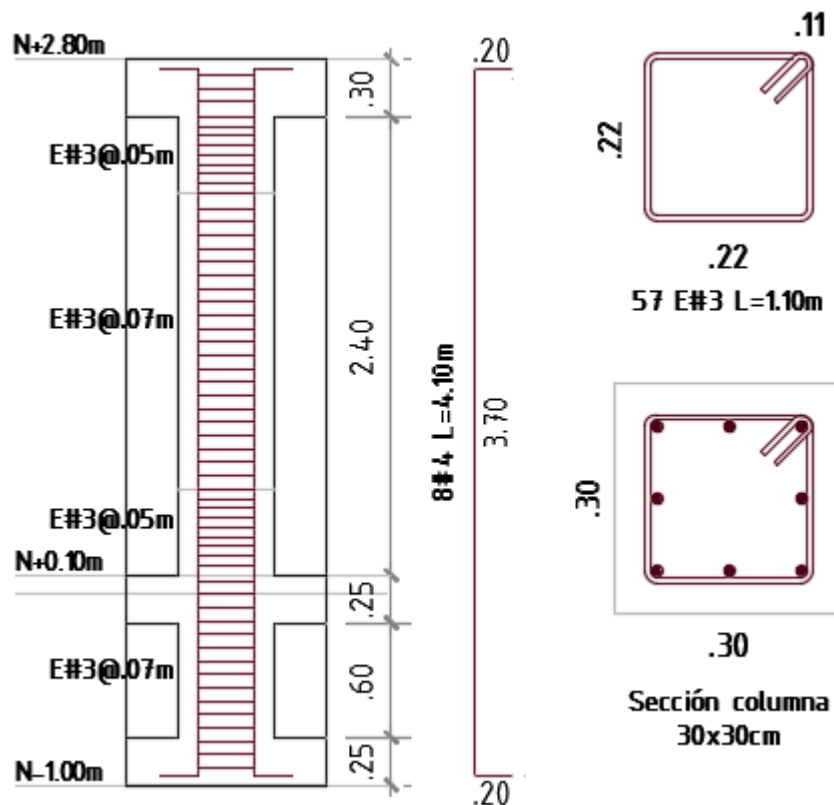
Detalle de columna típica en sistema tipo pórtico de dos pisos
